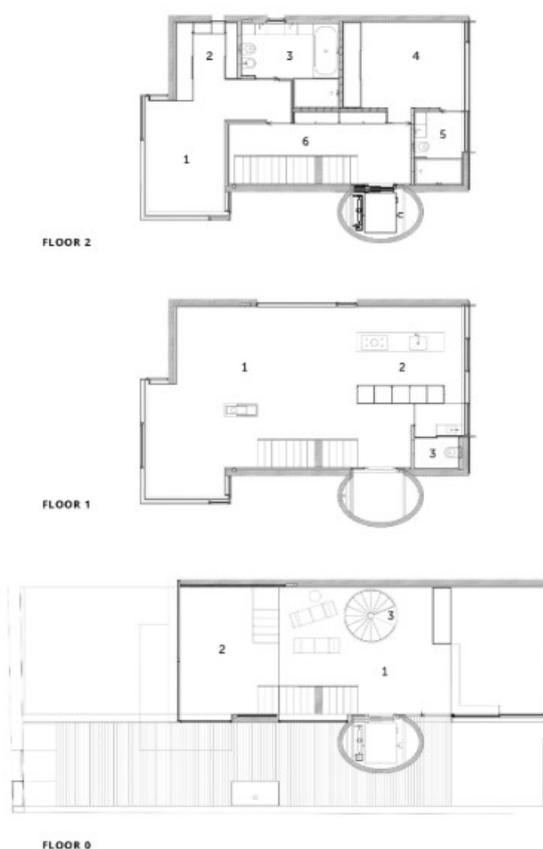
Planta da fração N – (Fonte: Projeto Arquitetura, 2019)
